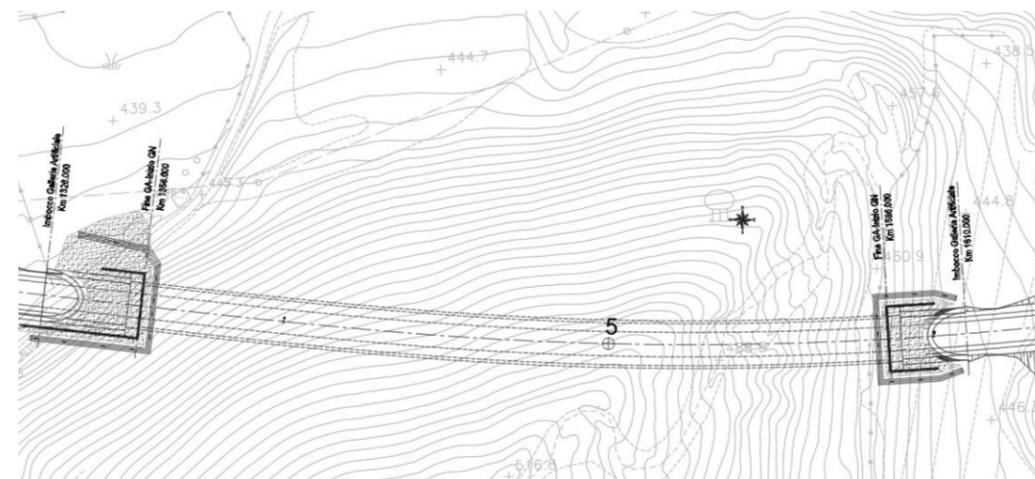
Stralci planimetrici della galleria "Mercatello 1"
